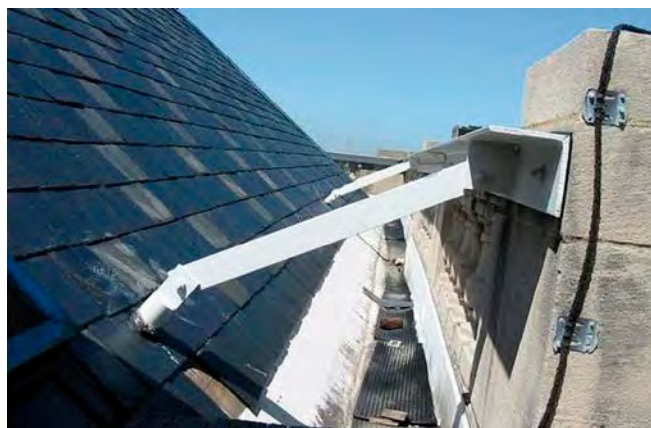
> Mesures applicables aux parapets sur toiture
